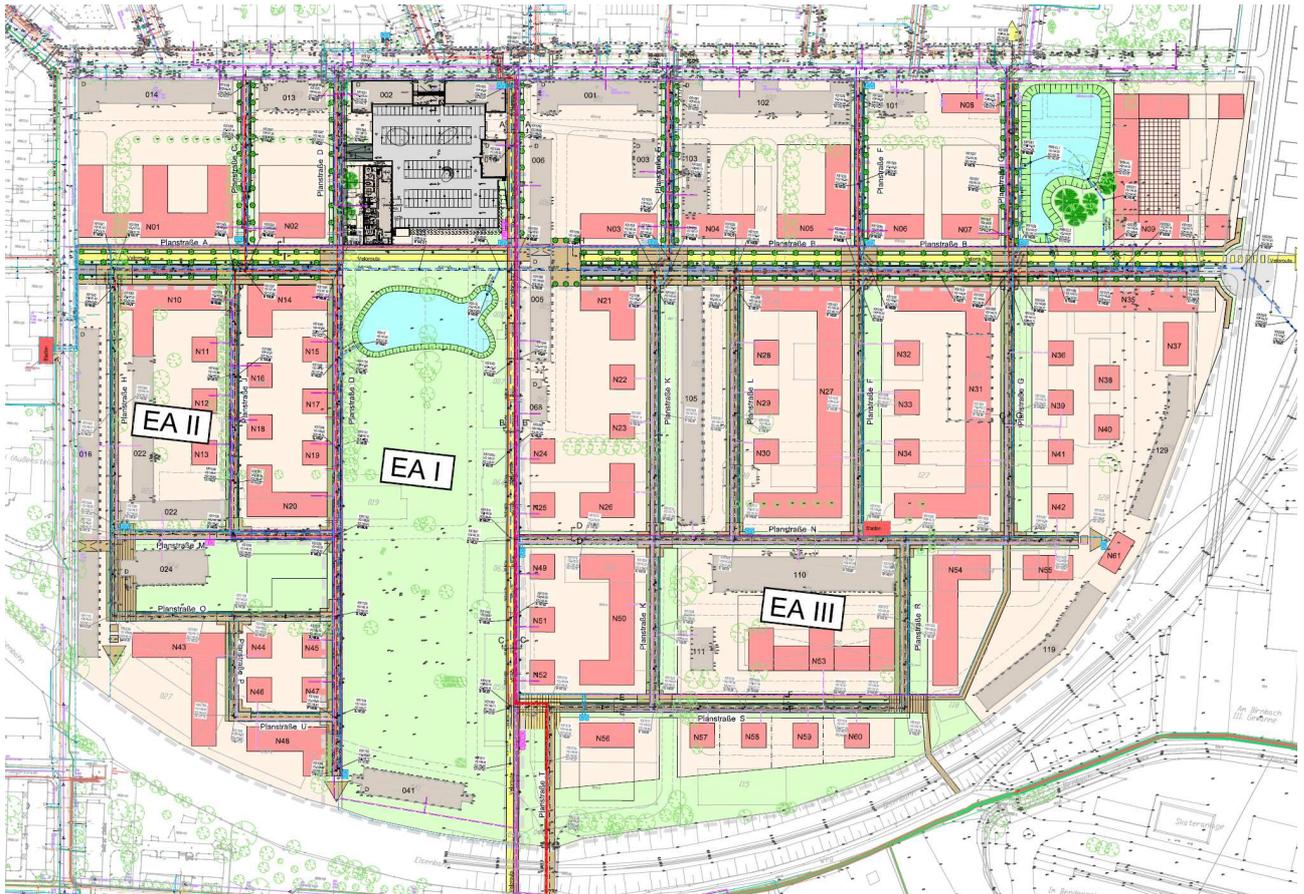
Bit Consult GmbH, Frielzheimer Straße 3, 70499 Stuttgart: Erschließung „Wohnpark Am Ebenberg“, Masterlageplan, Stand 19.01.2011
